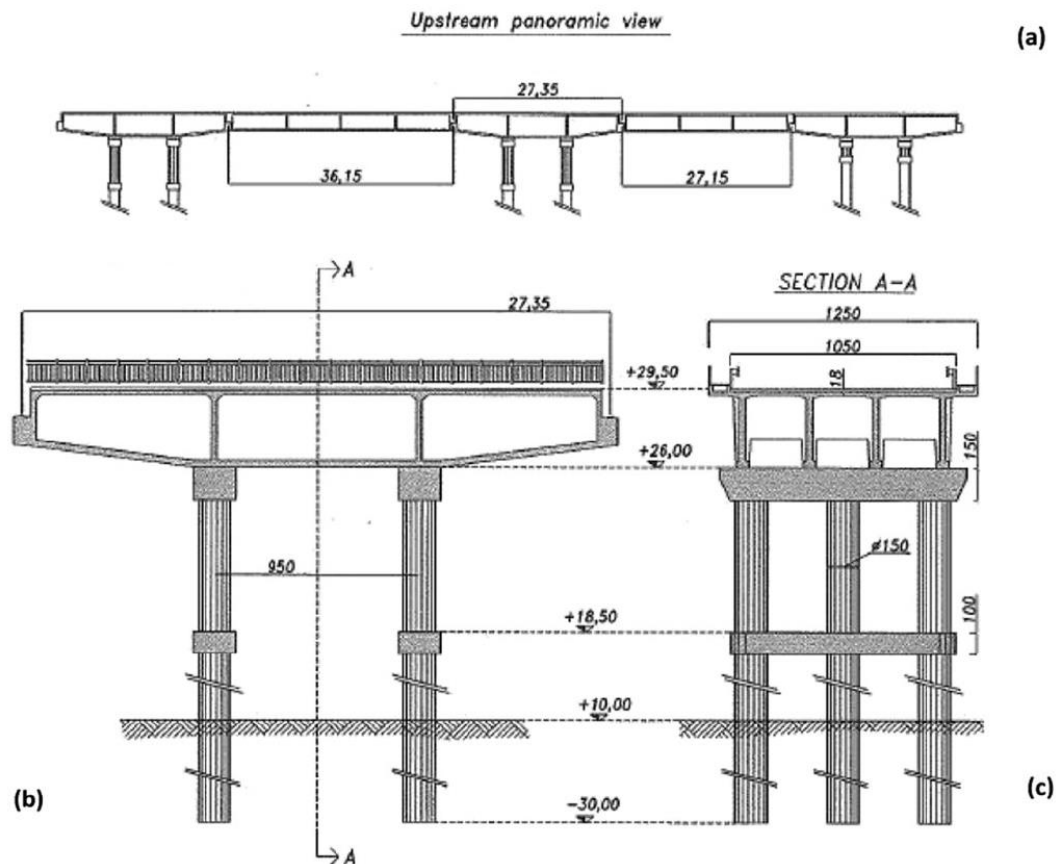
Geometria del ponte: (a) panoramica longitudinale di monte; (b) dettaglio pila 33; e (c) sezione trasversale della pila 33 [20]
